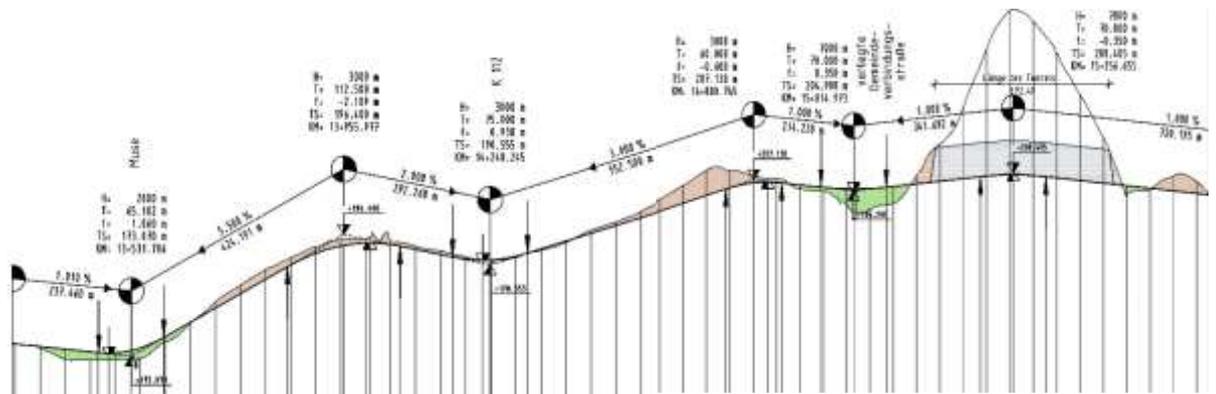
Höhenplan: geländenahe Trassierung – 10-fach überhöht dargestellt
